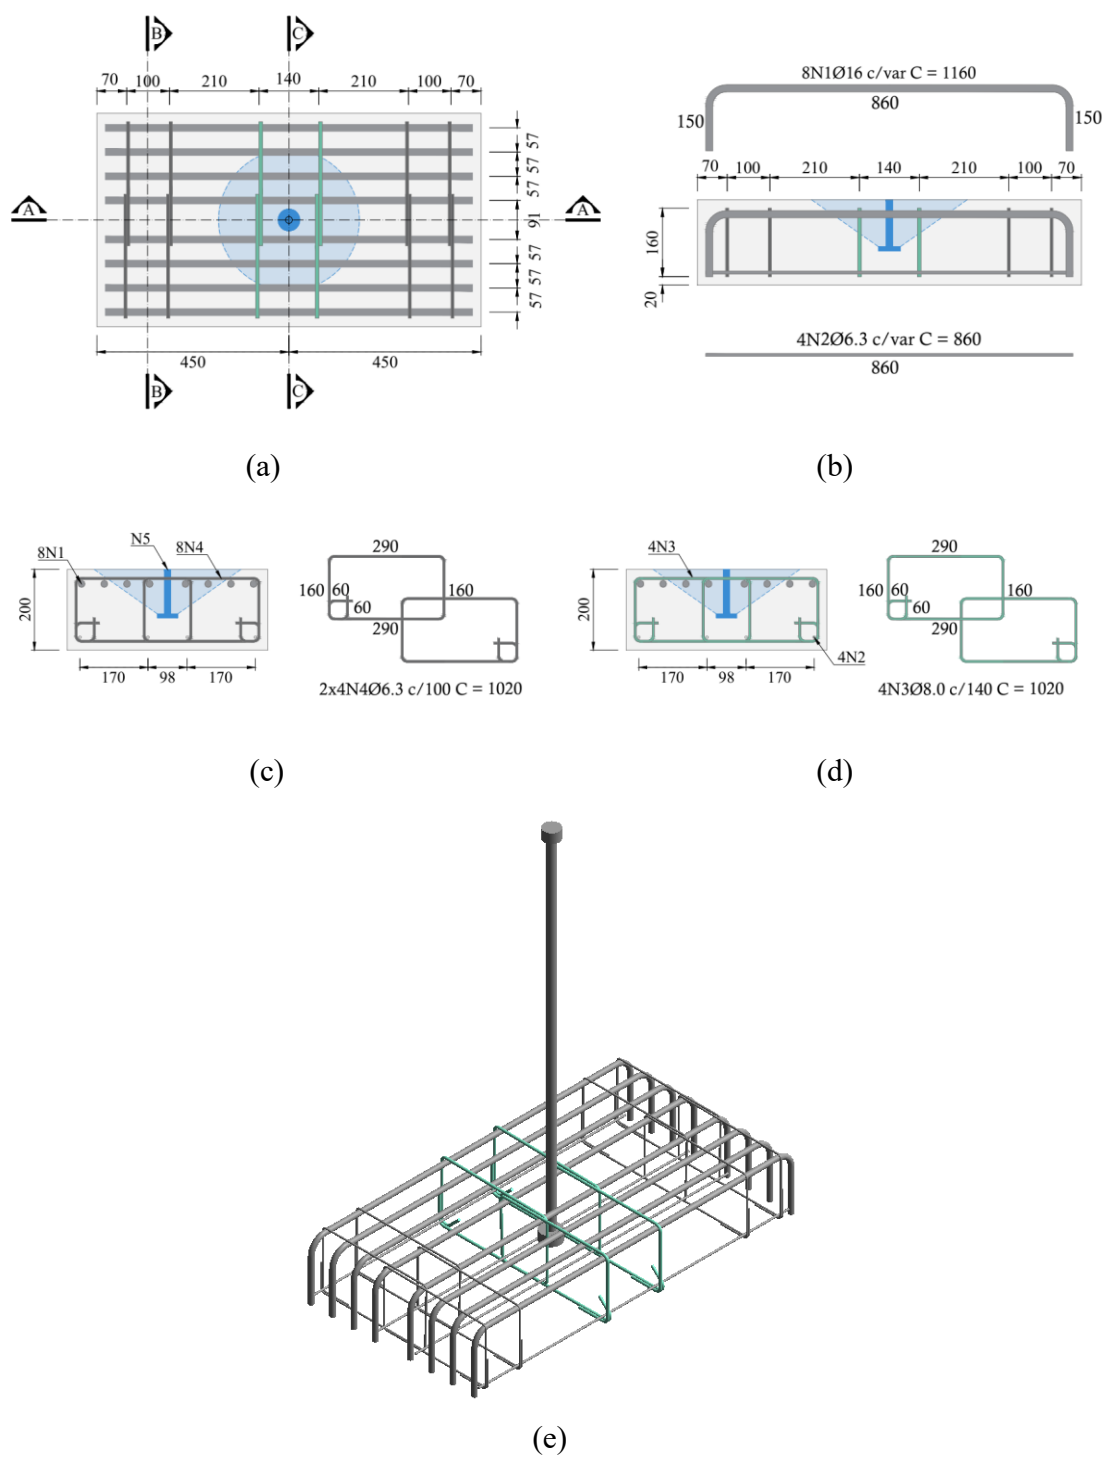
Projeto executivo da série 3: (a) Planta Baixa; (b) Corte AA; (c) Corte BB; (d) Corte CC.
